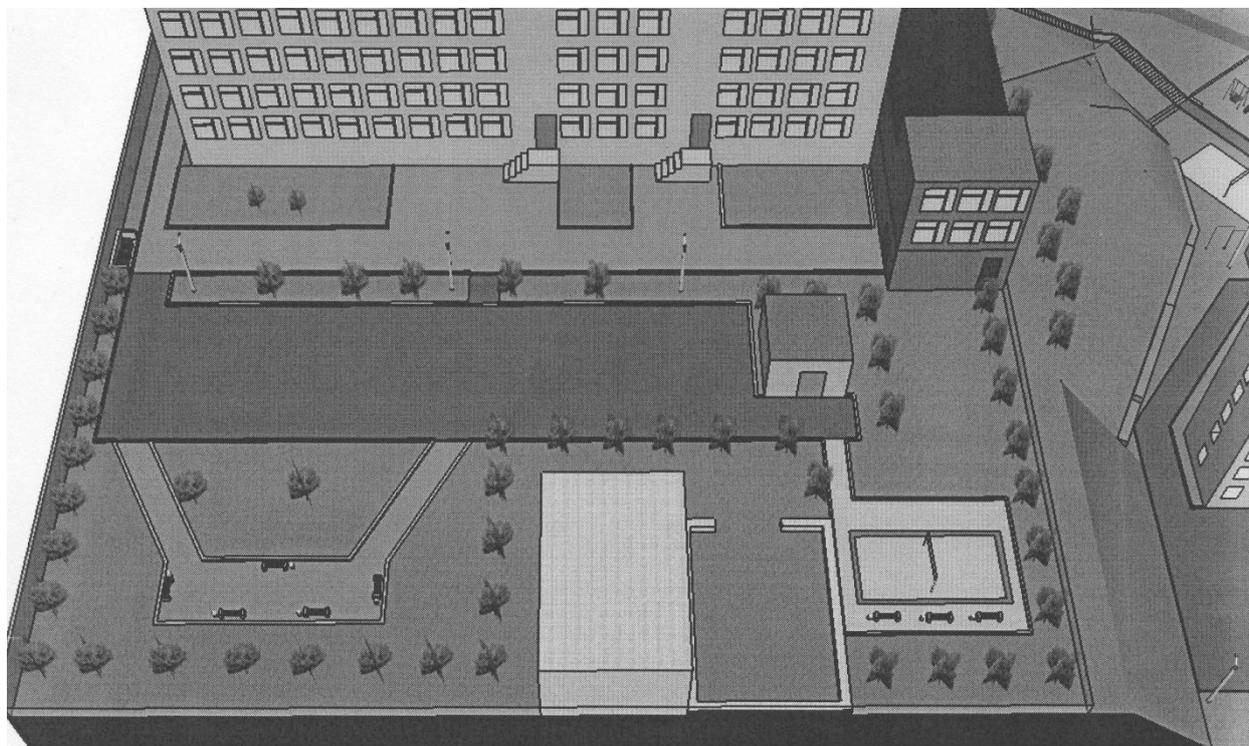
Общий вид плана благоустройства территории учебного корпуса ИЗКиП
